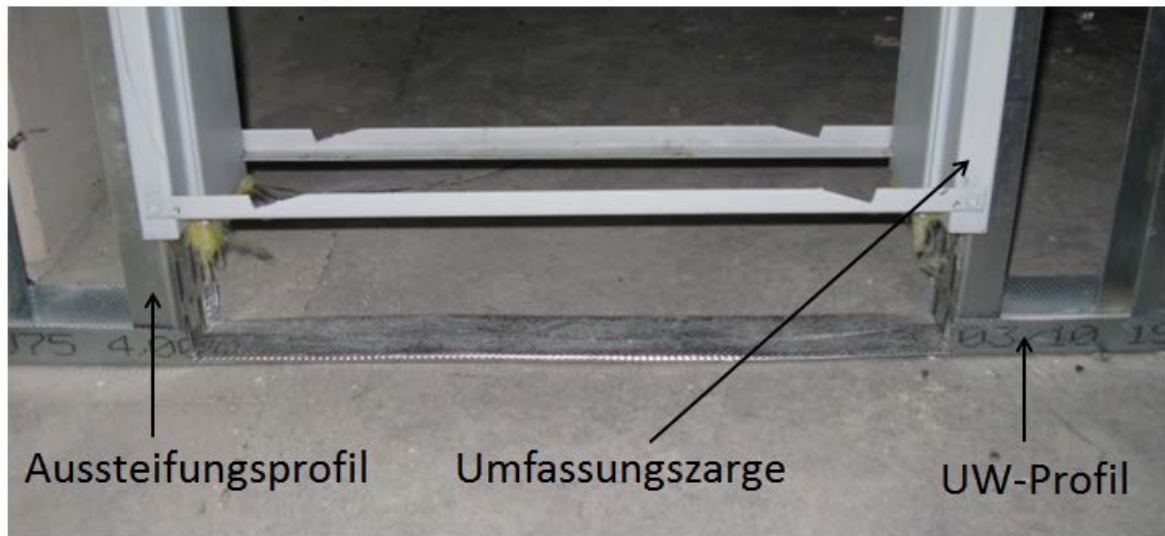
Einbau einer Umfassungszarge in die Metallständer Unterkonstruktion¹³⁵
